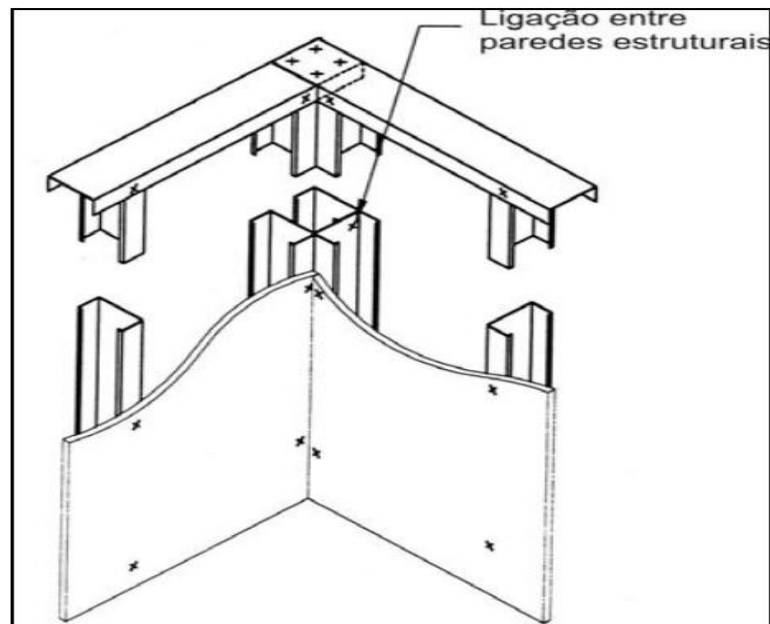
Detalhes da conexão dos elementos estruturais entre duas paredes. Fonte: Centro Brasileiro em Construção em Aço.
